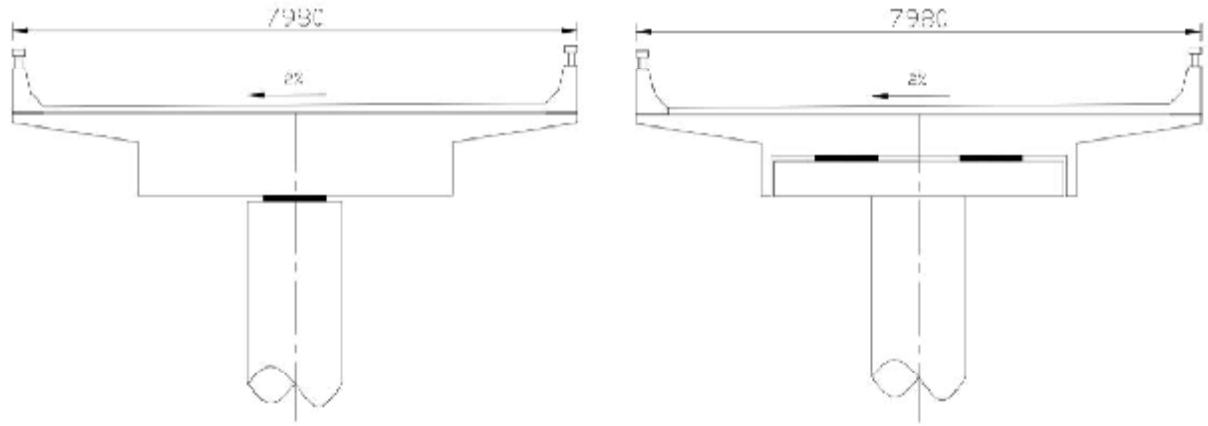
A 匝道桥梁端截面示意图 (单位: mm)
